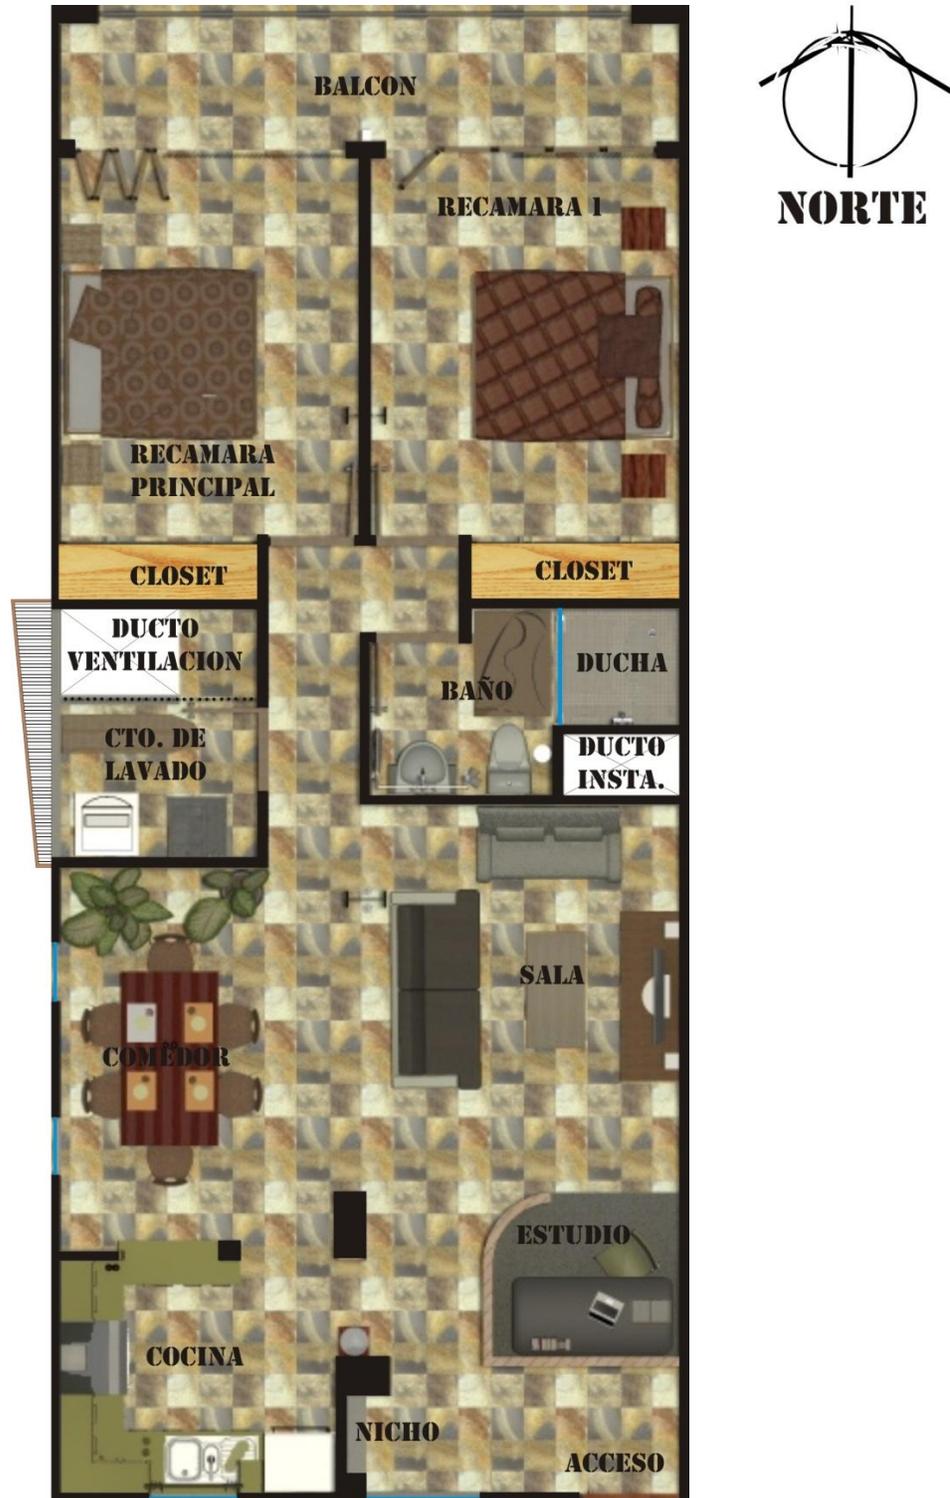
Planta arquitectónica, vivienda tipo. Fuente, archivo personal.
